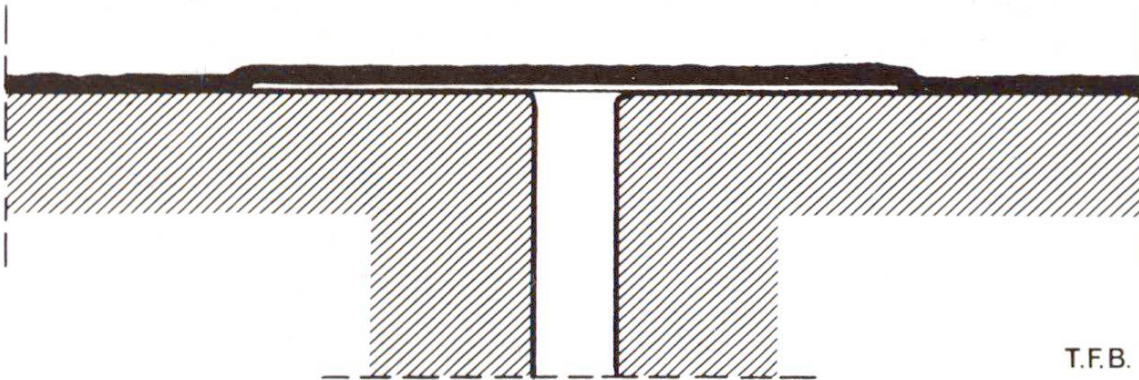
L'enduit de protection, suffisamment élastique, enjambe le joint sur un support également élastique.
